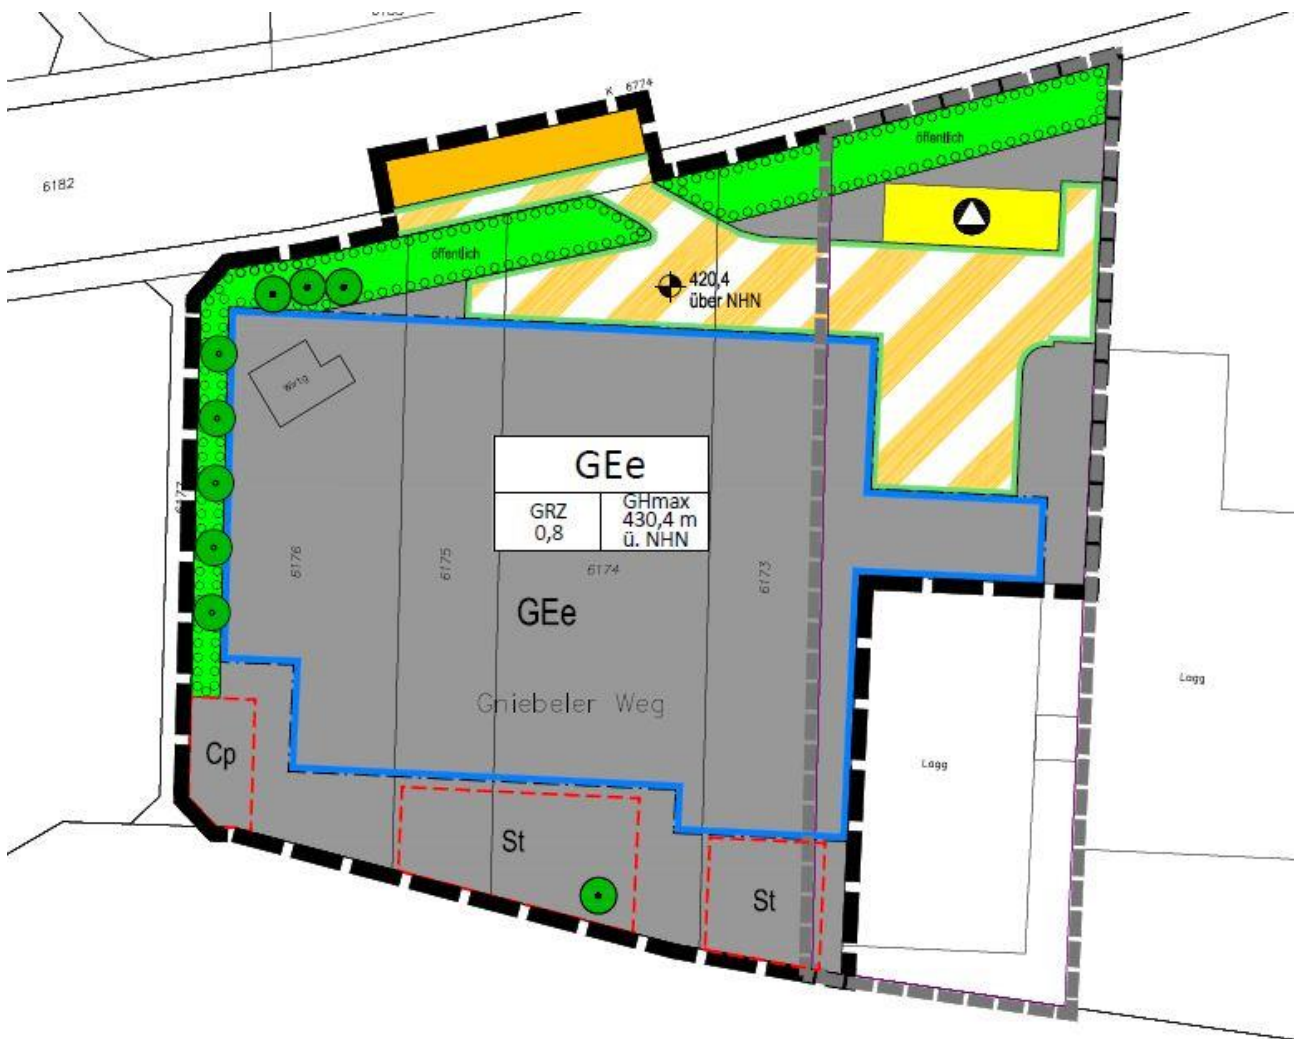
Bebauungsplan vom 20.02.24 (FIRU mbH 2024)
